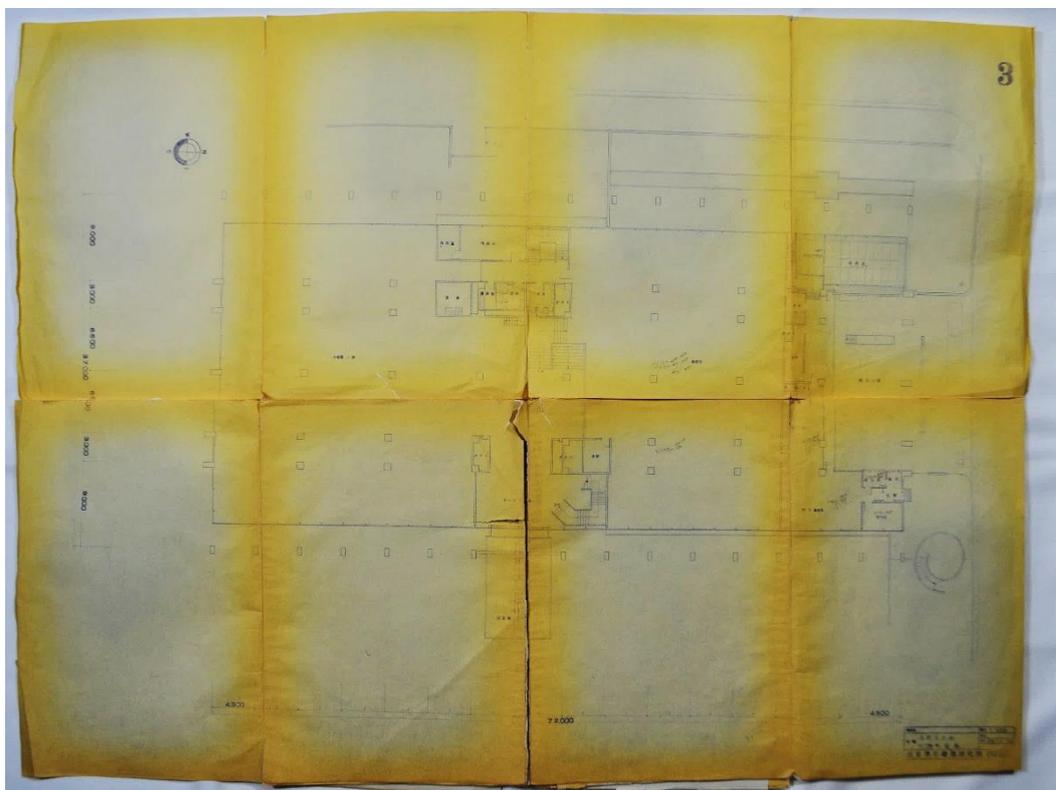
「設計図」上野市庁舎2階平面図 1963年(昭和38)10月8日(1:100)
